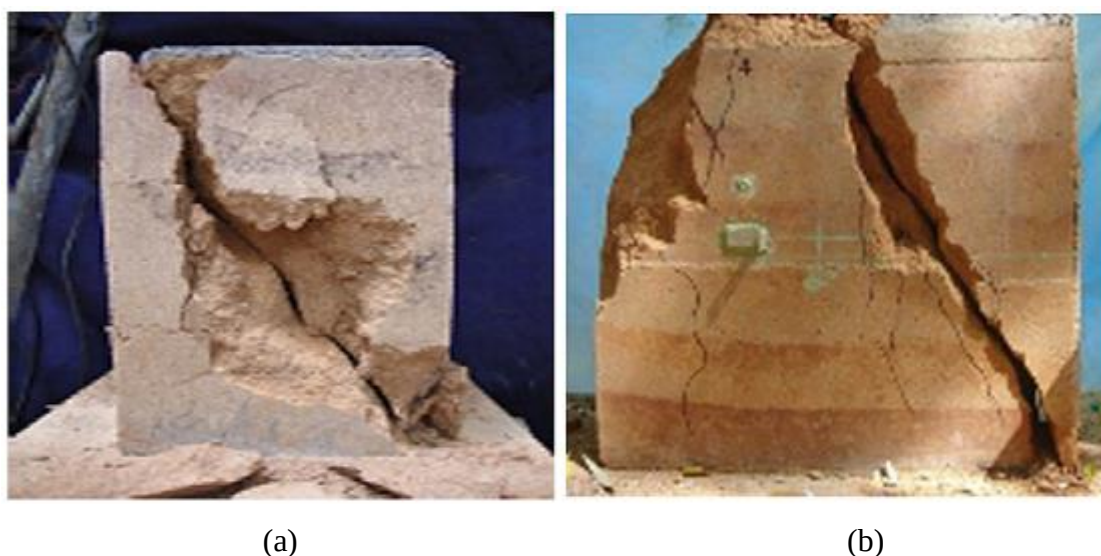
Mapa de fissuras da taipa de pilão.
